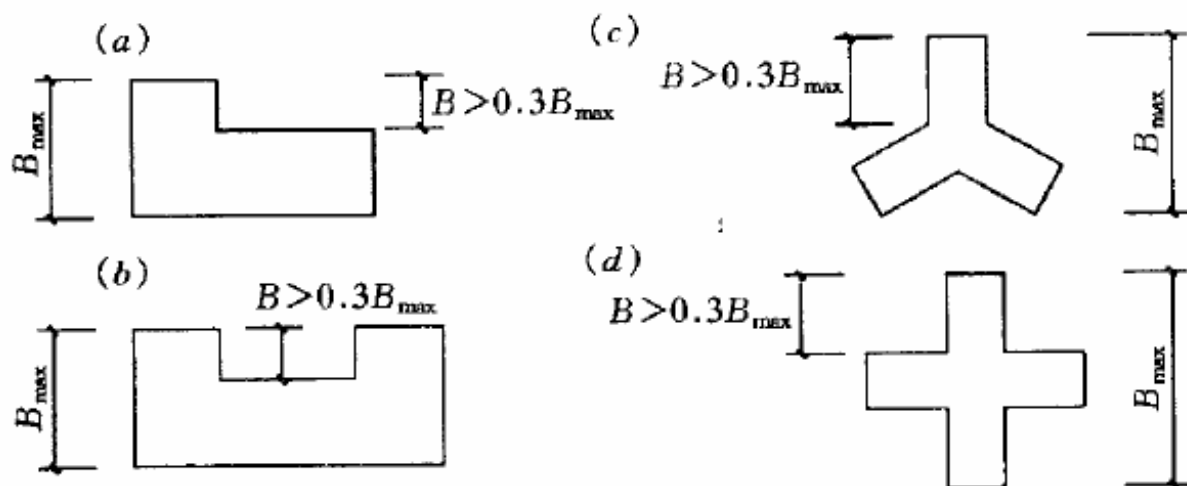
建筑结构平面的凹角或凸角不规则示例
